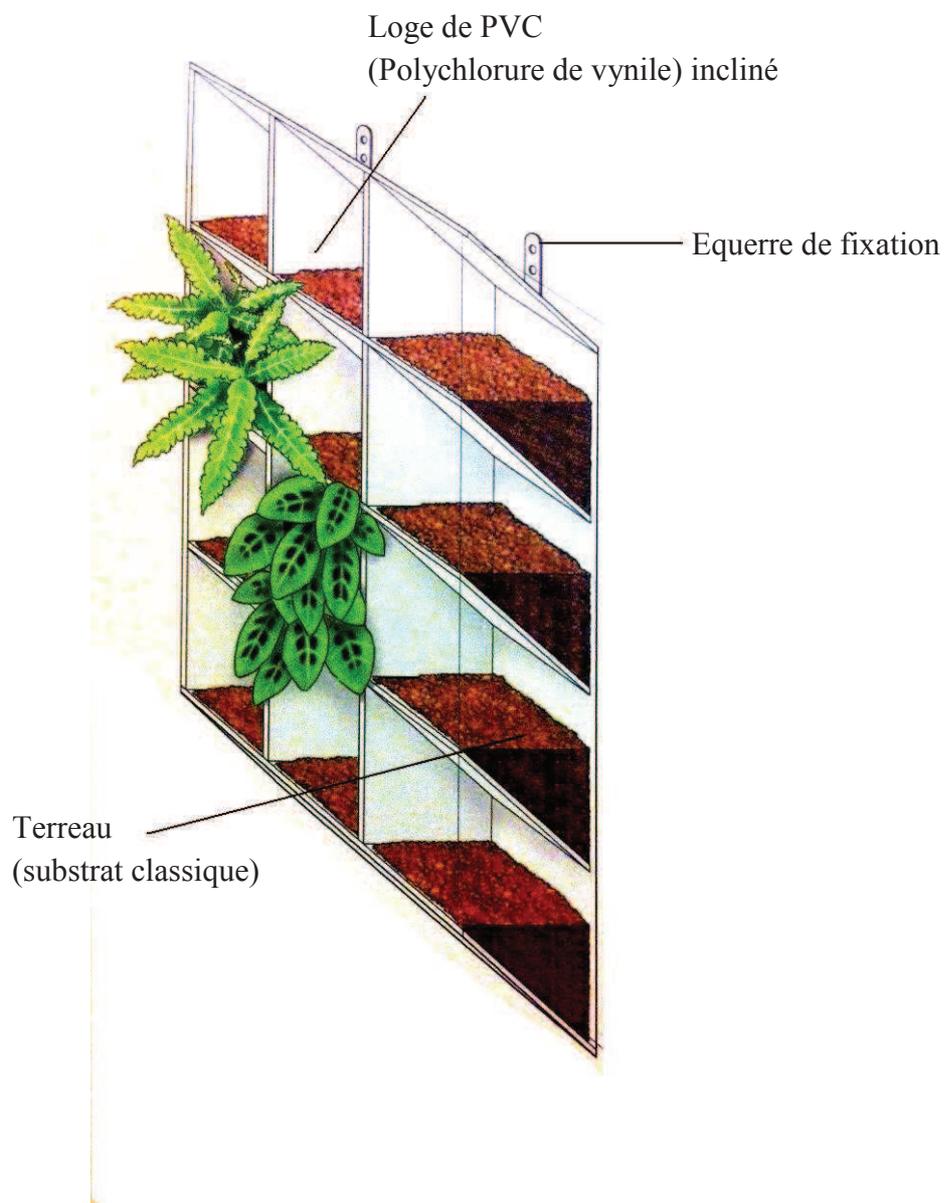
Les casiers à plantes, (Groult J-M., 2008).
